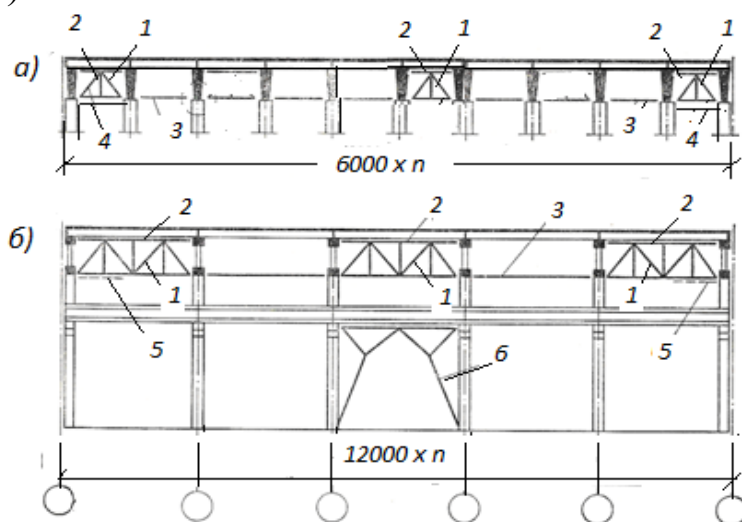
Связи в покрытиях при железобетонных стропильных конструкциях: а) - вертикальных и горизонтальных связей при шаге колонн 6,0 м; б) - то же, при шаге колонн 12,0 м; 1- вертикальная связь по фермам при шаге колонн 6,0 и 12,0 м; 2- связевые фермы по верхнему поясу стропильных ферм; 3 - горизонтальная распорка между фермами; 4- горизонтальная ферма в торцах при шаге колонн 6,0 м; 5- то же, при шаге колонн 12,0 м; 6 - вертикальная связь при шаге колонн 12,0 м
